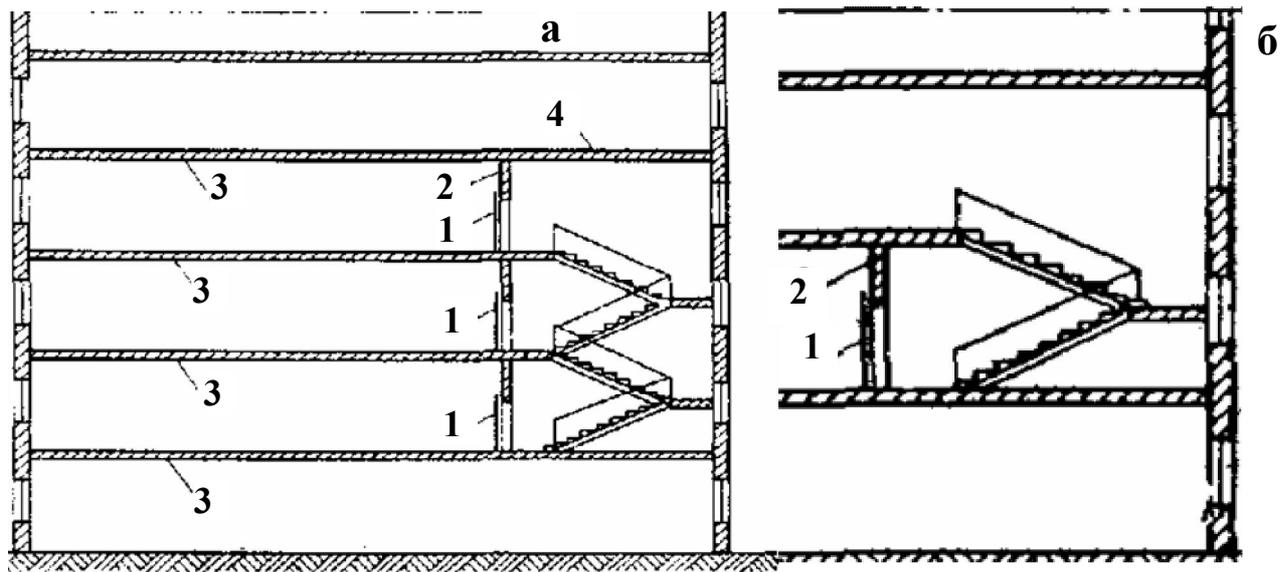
Схема влаштування сходів для з'єднання поверхів: а – трьох поверхів і більше; б – двох поверхів; 1 – протипожежні двері; 2 – стіна сходової клітки; 3 – міжповерхове перекриття; 4 – перекриття над сходовою кліткою
